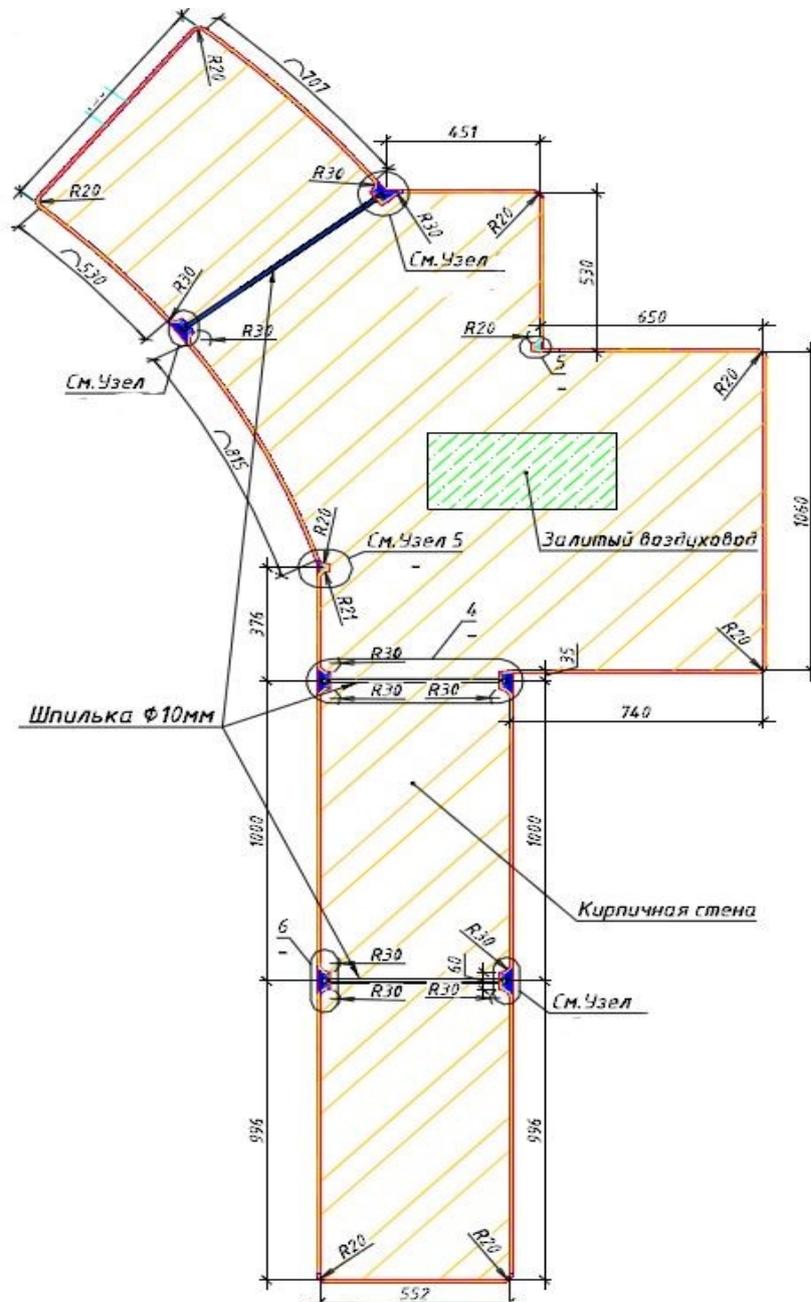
Обойма из стекловолокна и узел крепления армирующей сетки к кирпичной стене
